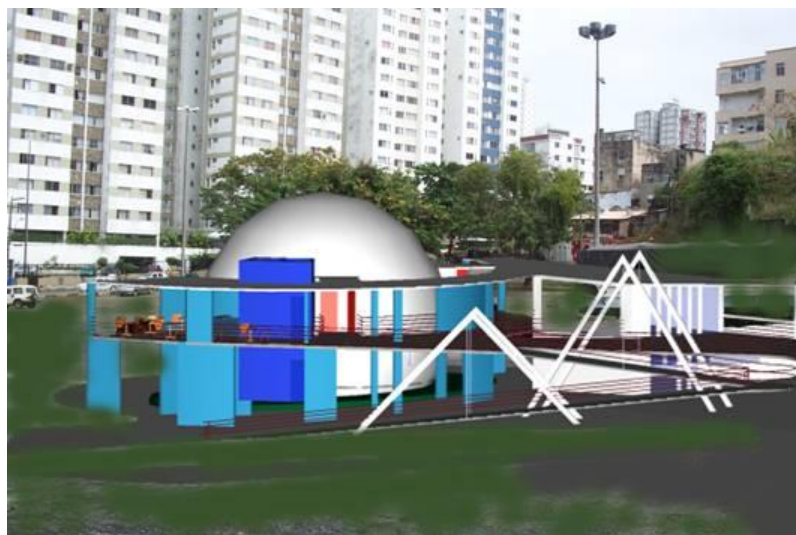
Projeto: Planetário. Modelo tridimensional com vista da proposta final, inserida no local.
